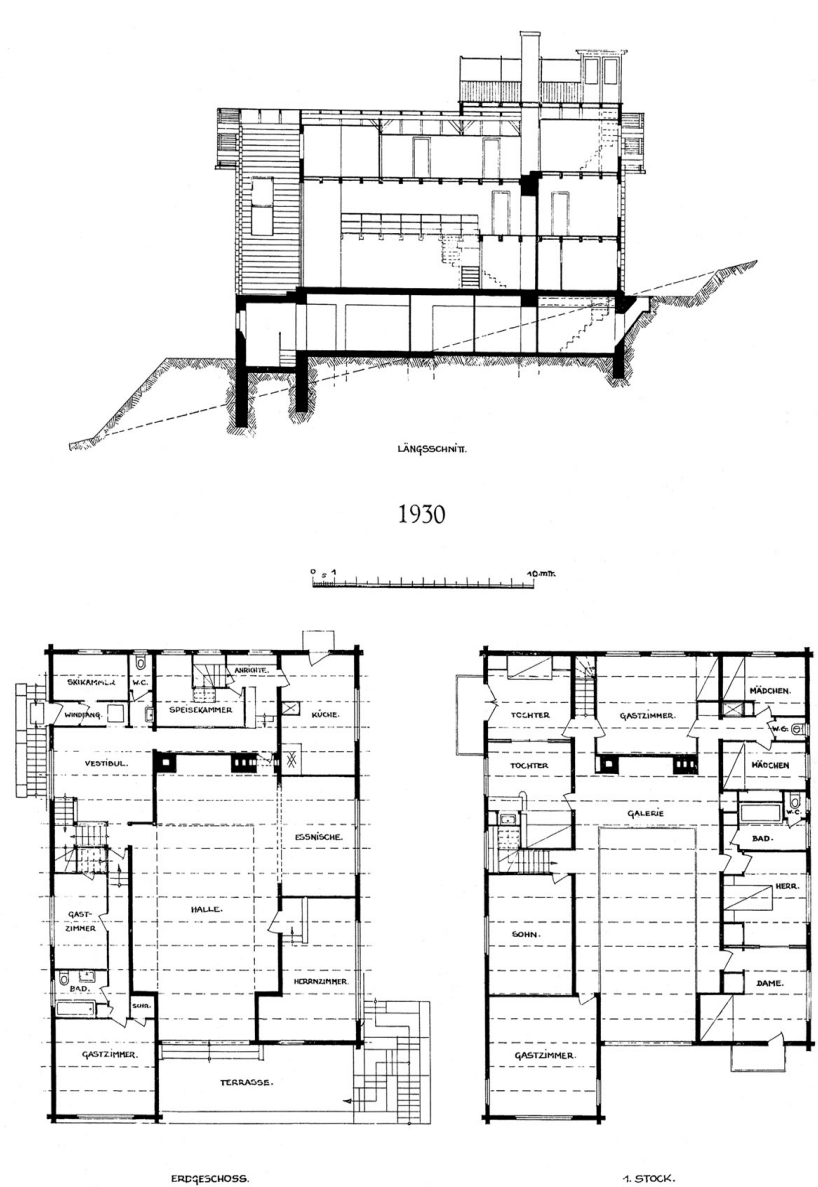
/246. Landhaus K., Payerbach bei Wien. Schnitt und Grundrisse
